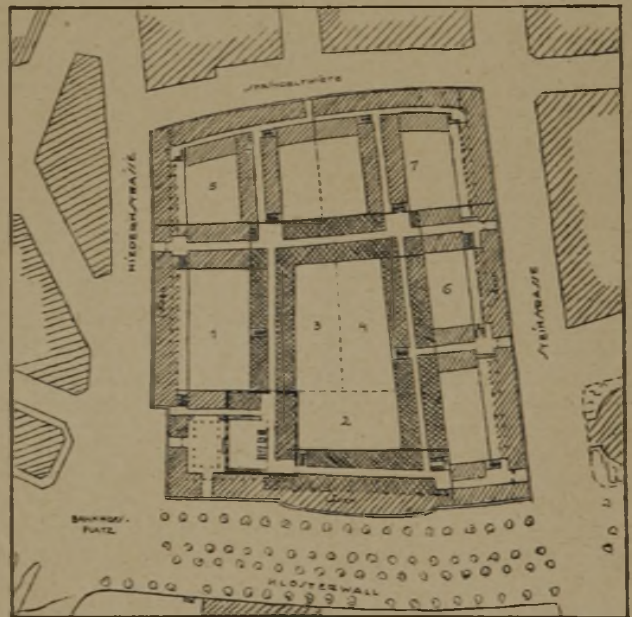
(rechts). Grundriß des Messehauses nach der Fink'schen Studie.
